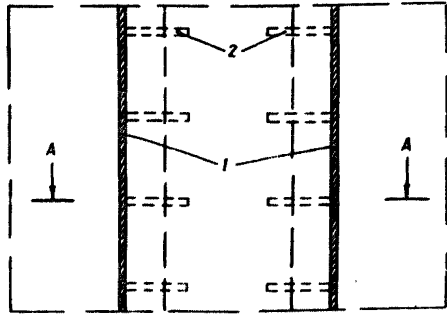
Способ предварительного крепления выработок со стороны кровли по нижележащему слою с помощью анкеров:
